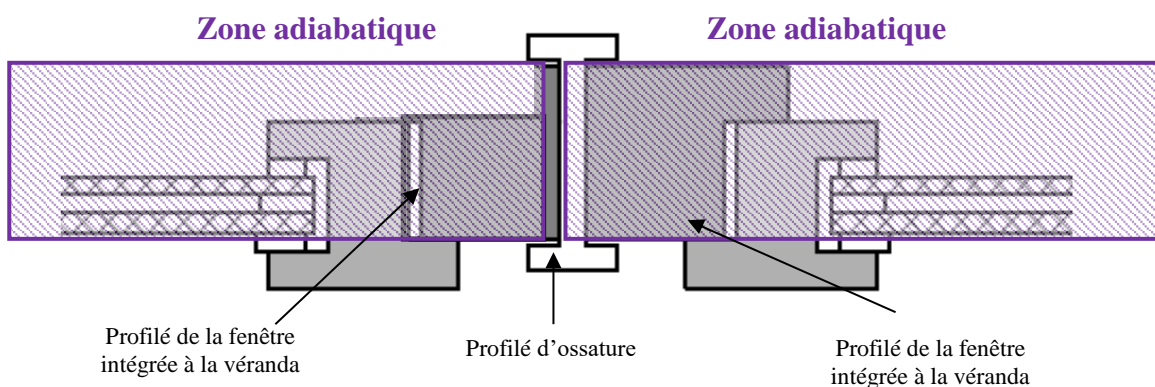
Coupe d'un profilé d'ossature liant deux fenêtres (partie plane)
